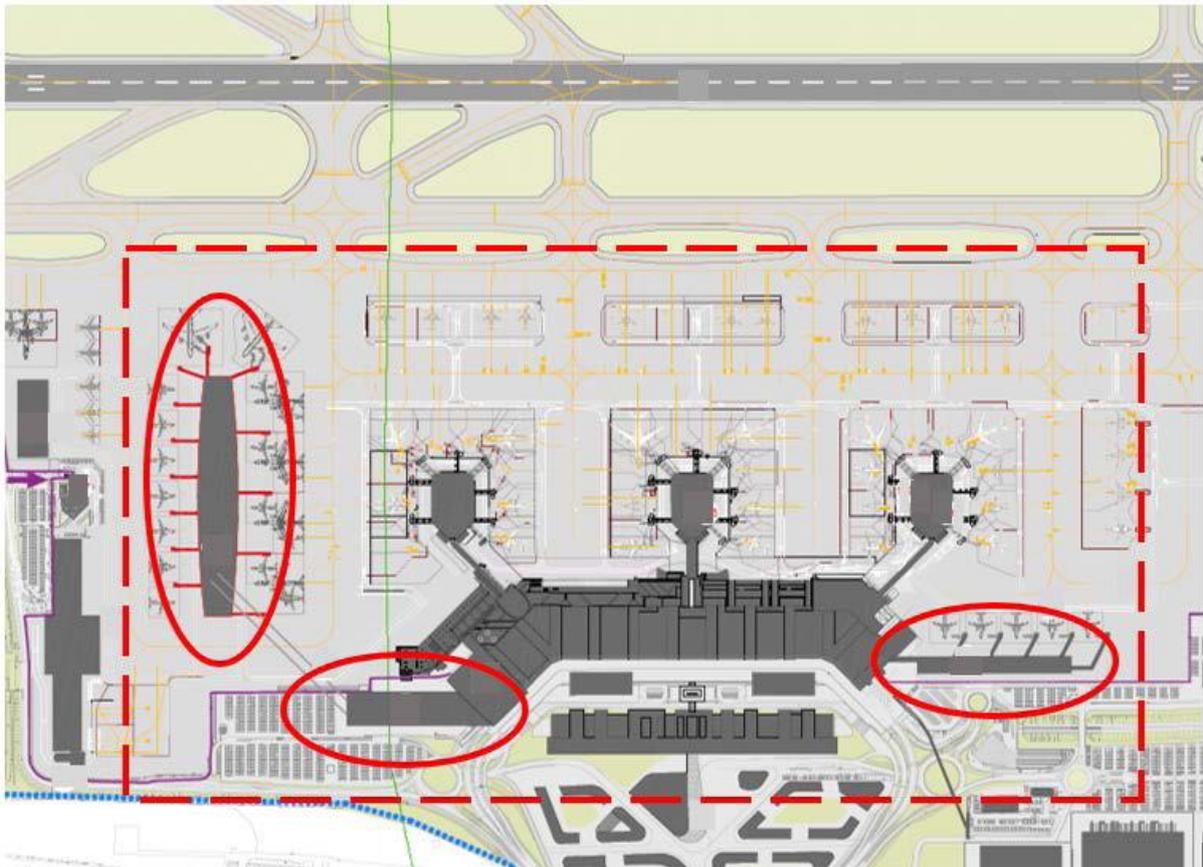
Ipotesi 1 schema di layout fonte: Masterplan 2035
